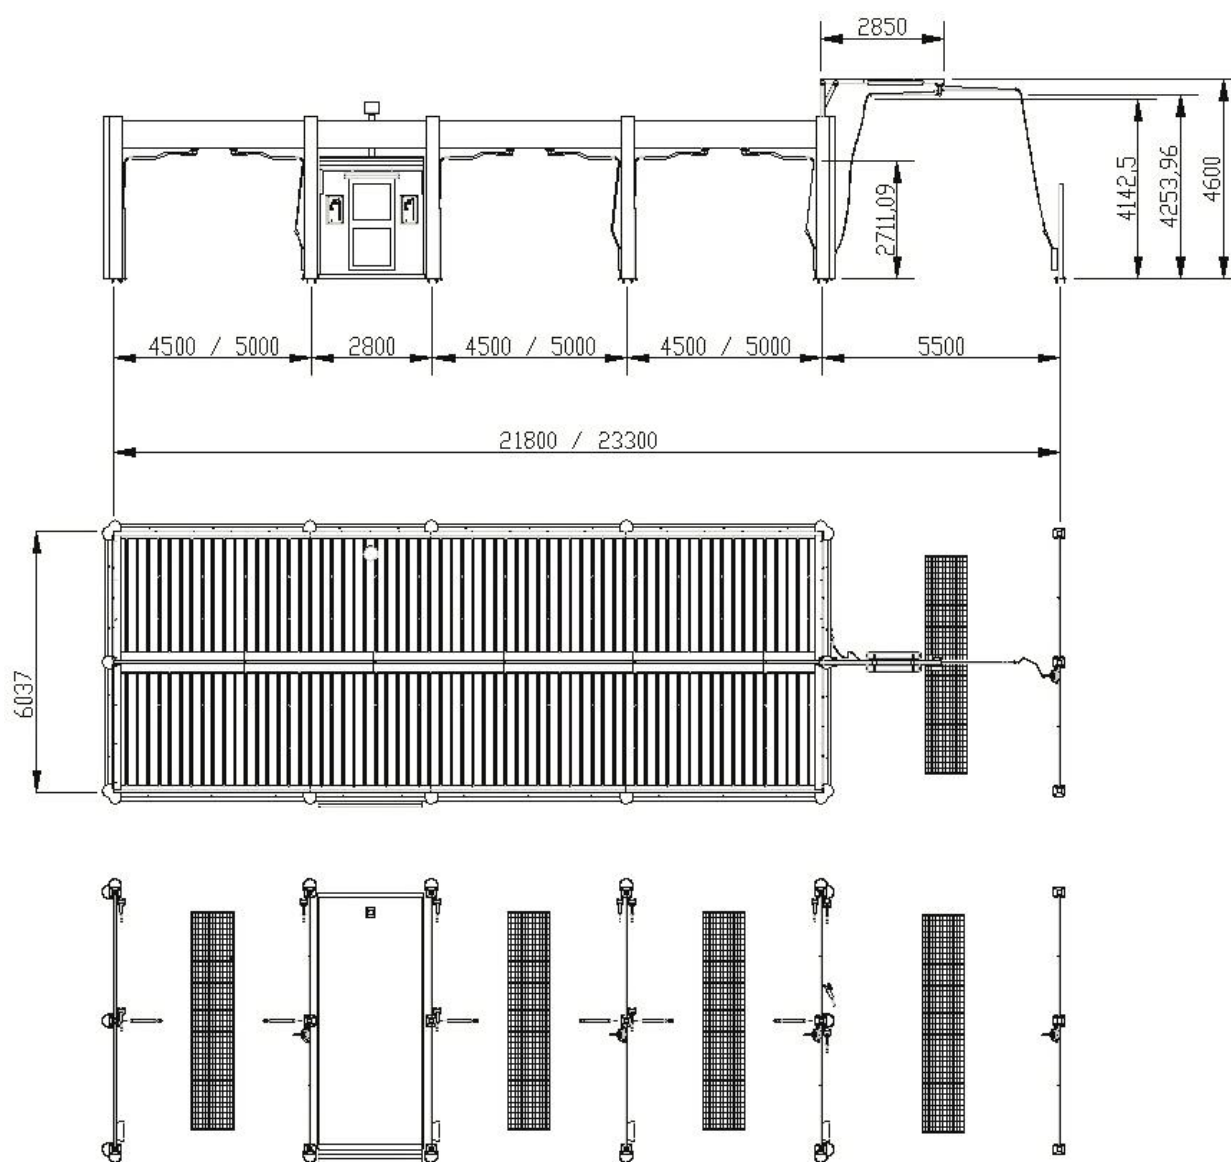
Dimensioni piste di lavaggio con Locale Tecnico
